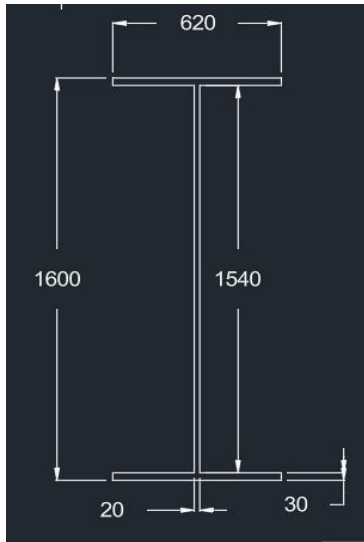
Dimensiones de la viga tipo I en mm. Elaboración propia.
